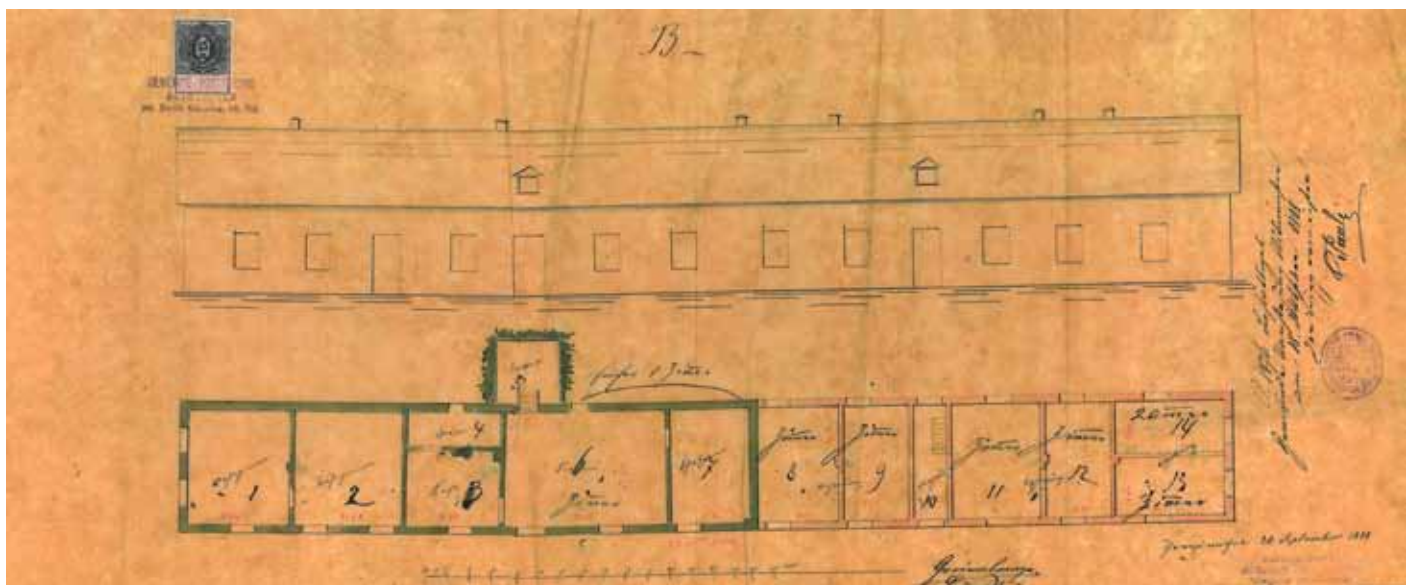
Theresiental, Grundrissplan der ersten Siedlung um 1888.
